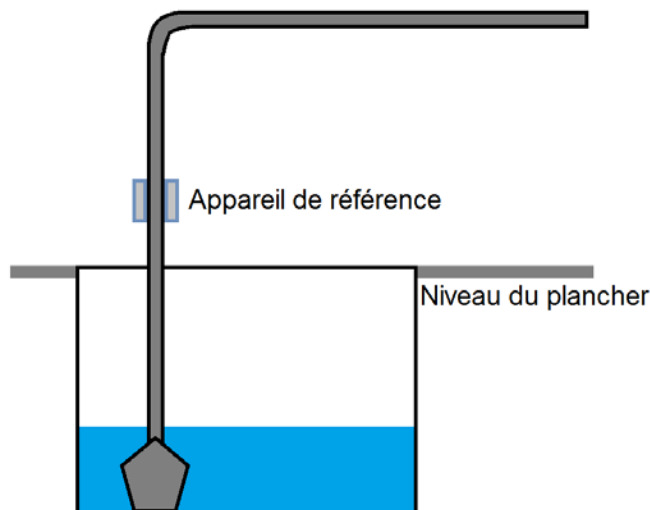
Exemple d'installation impliquant un appareil de référence installé temporairement sur une conduite fermée
